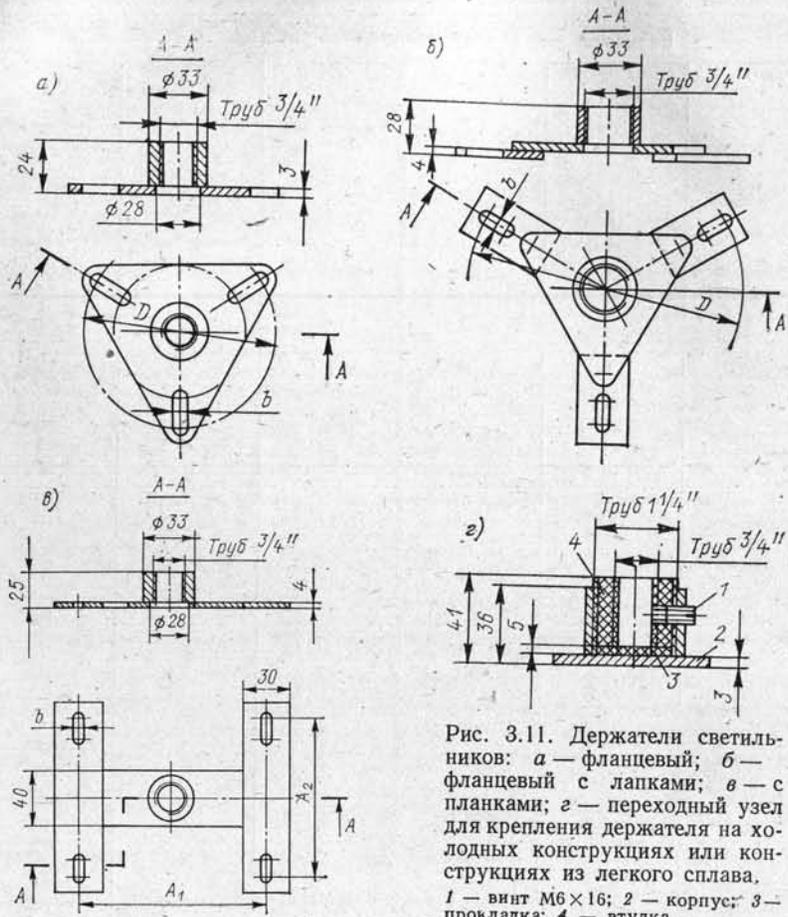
Держатели светильников: а — фланцевый; б — фланцевый с лапками; в — с планками; г — переходный узел для крепления держателя на холодных конструкциях или конструкциях из легкого сплава. 1 — винт М6×16; 2 — корпус; 3 — прокладка; 4 — втулка.
